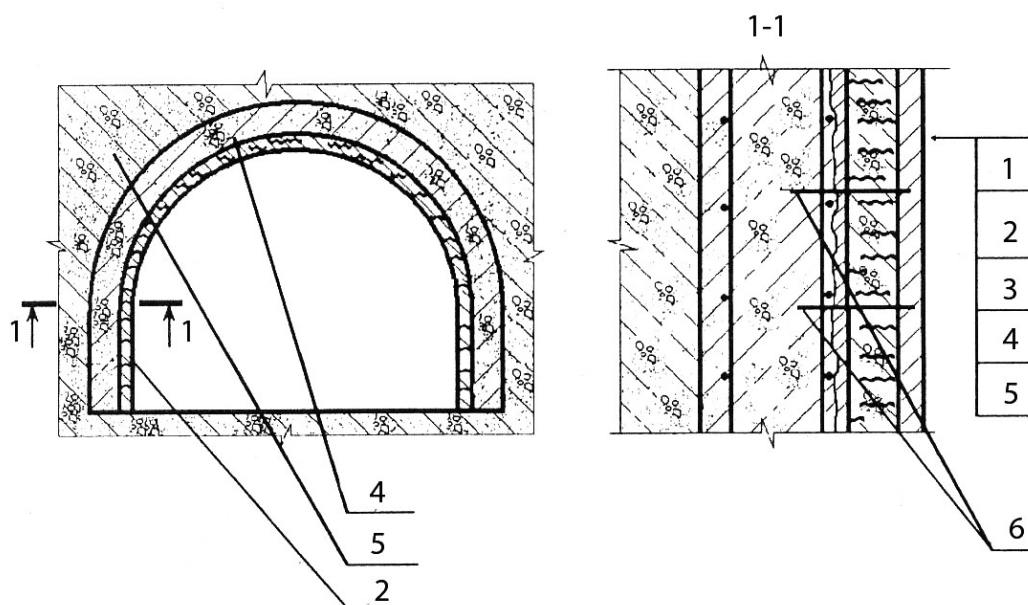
Примеры применения торкрет-фибробетонных защитных покрытий при ремонте строительных конструкций и агрегатов, подвергаемых воздействиям высоких температур
